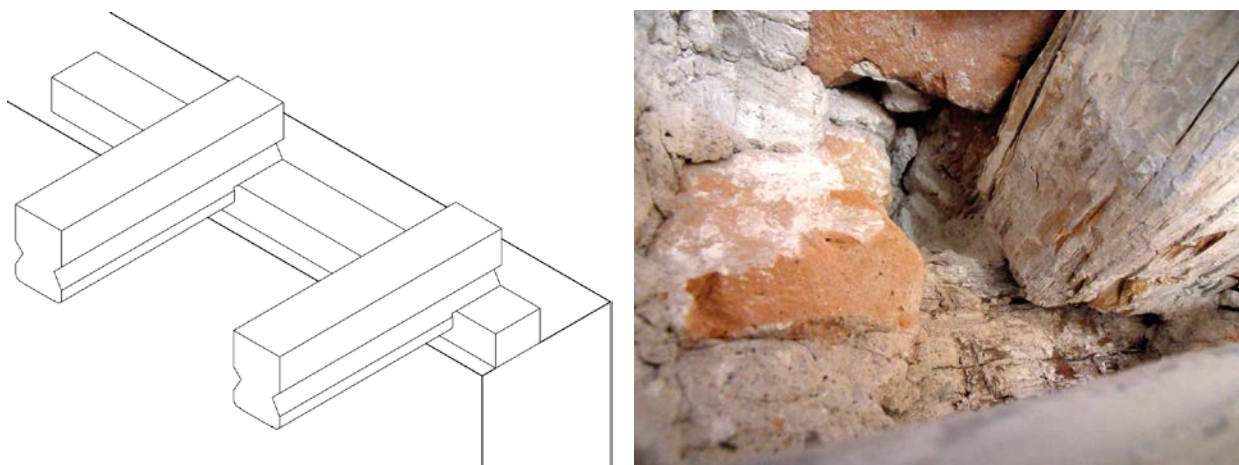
Apoyo con reducción de sección de las vigas I_V-16 a 20 sobre el durmiente I_V-21.
